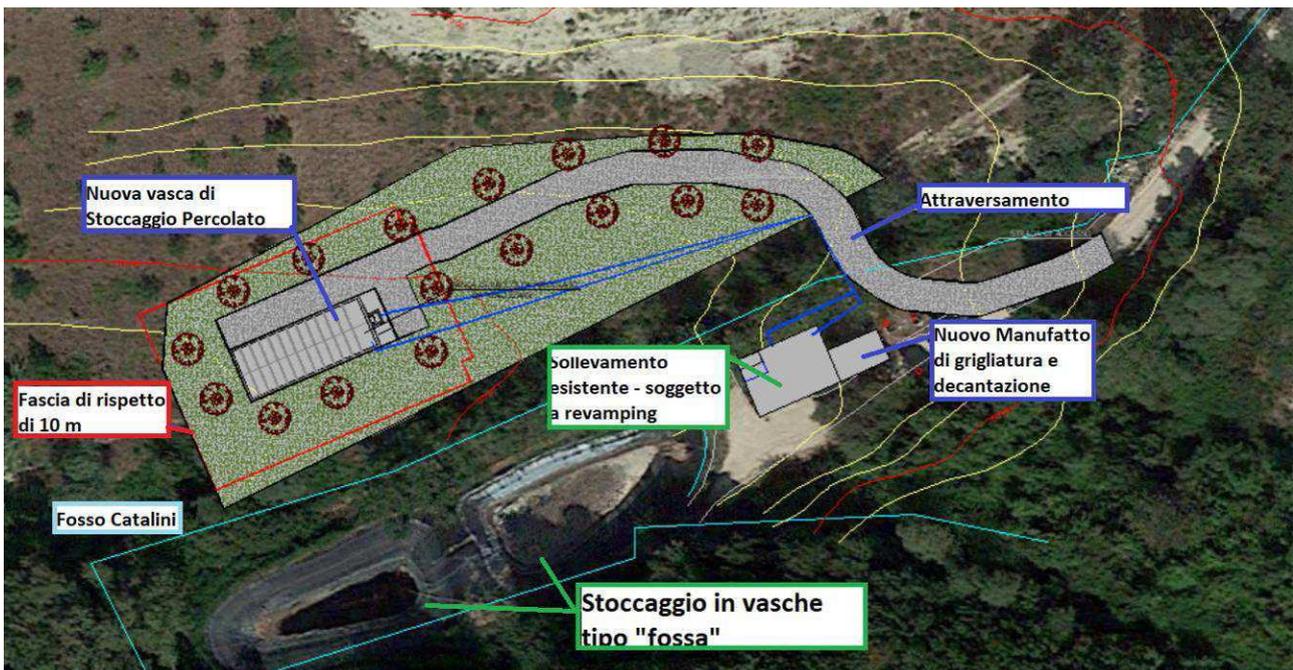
Planimetria di dettaglio zona intervento 1 con individuazione opere
